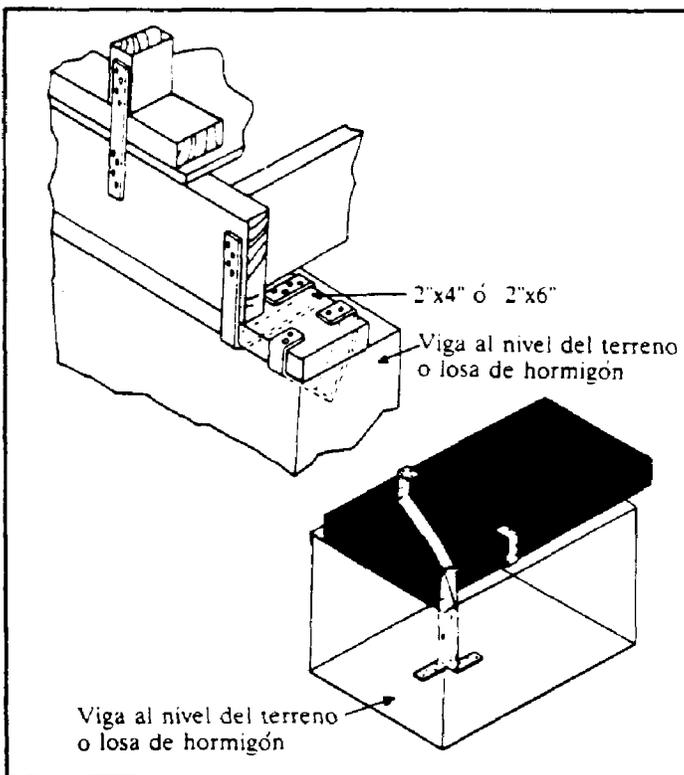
Uso de grapas o amarres para conectar una placa del fondo a un piso nuevo de hormigón
